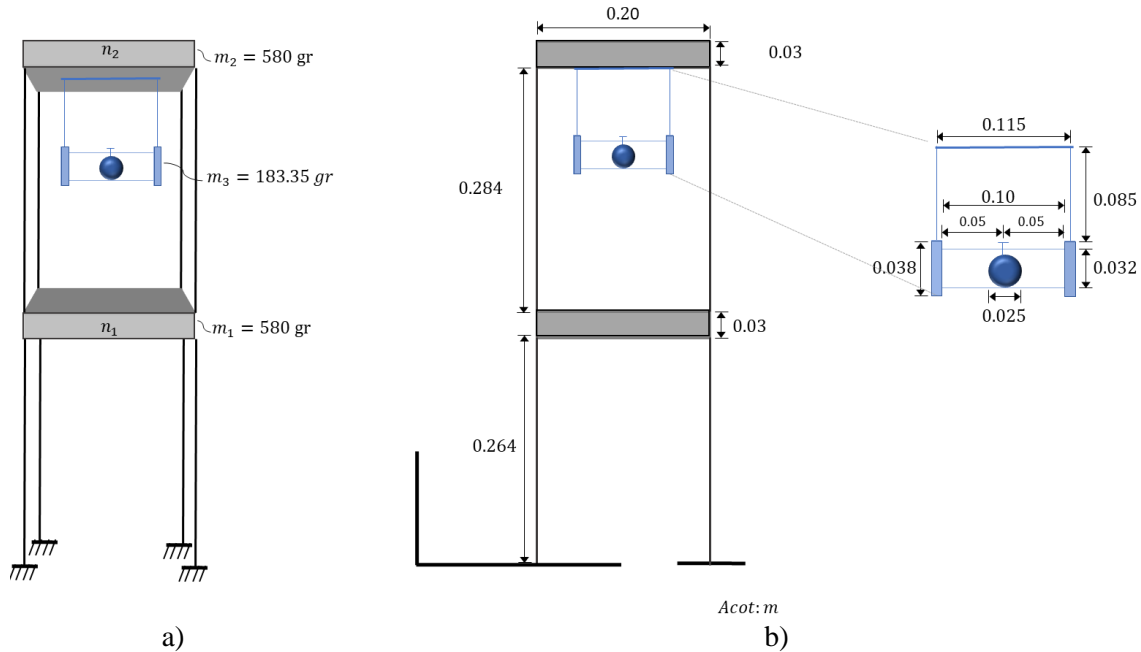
Vista esquemática de características del sistema de 2GDL con amortiguador de masa sintonizada para caso d_+ , ℓ_{v+} , m_{4+} a) vista 3D con masas y b) vista 2D con dimensiones y detalle de AMS
